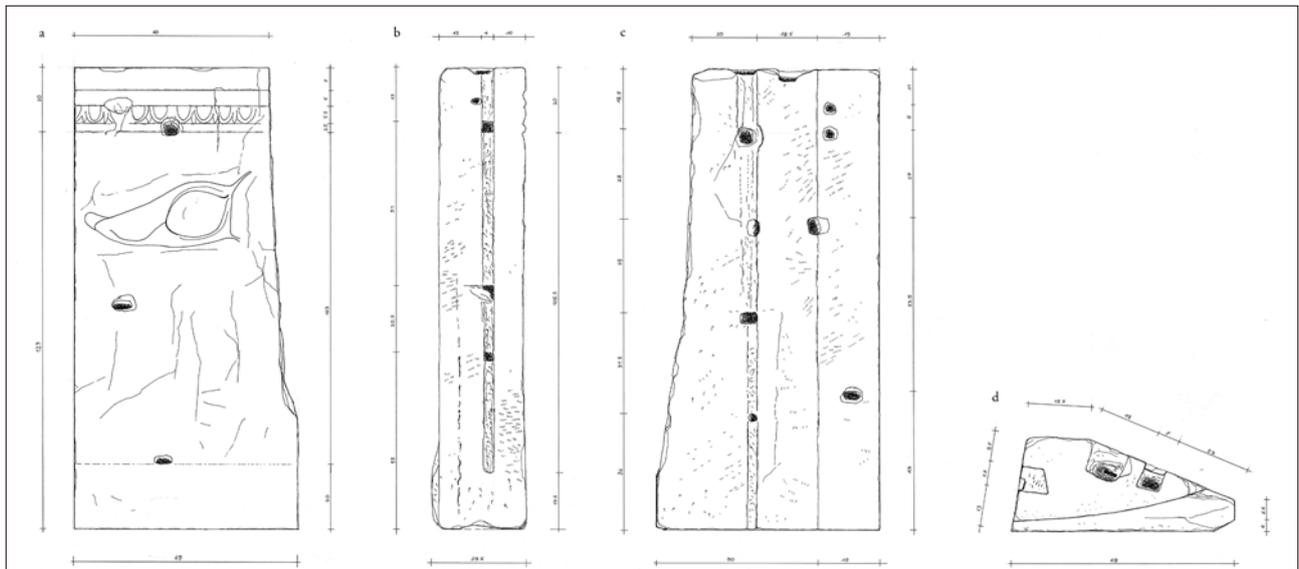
Rilievo della lastra del parapetto augusteo riusata come tombino nel rifacimento claudio: a) fronte, b) faccia laterale di contatto; c) retro; d) pianta del letto di attesa (ril. dell'A.).
